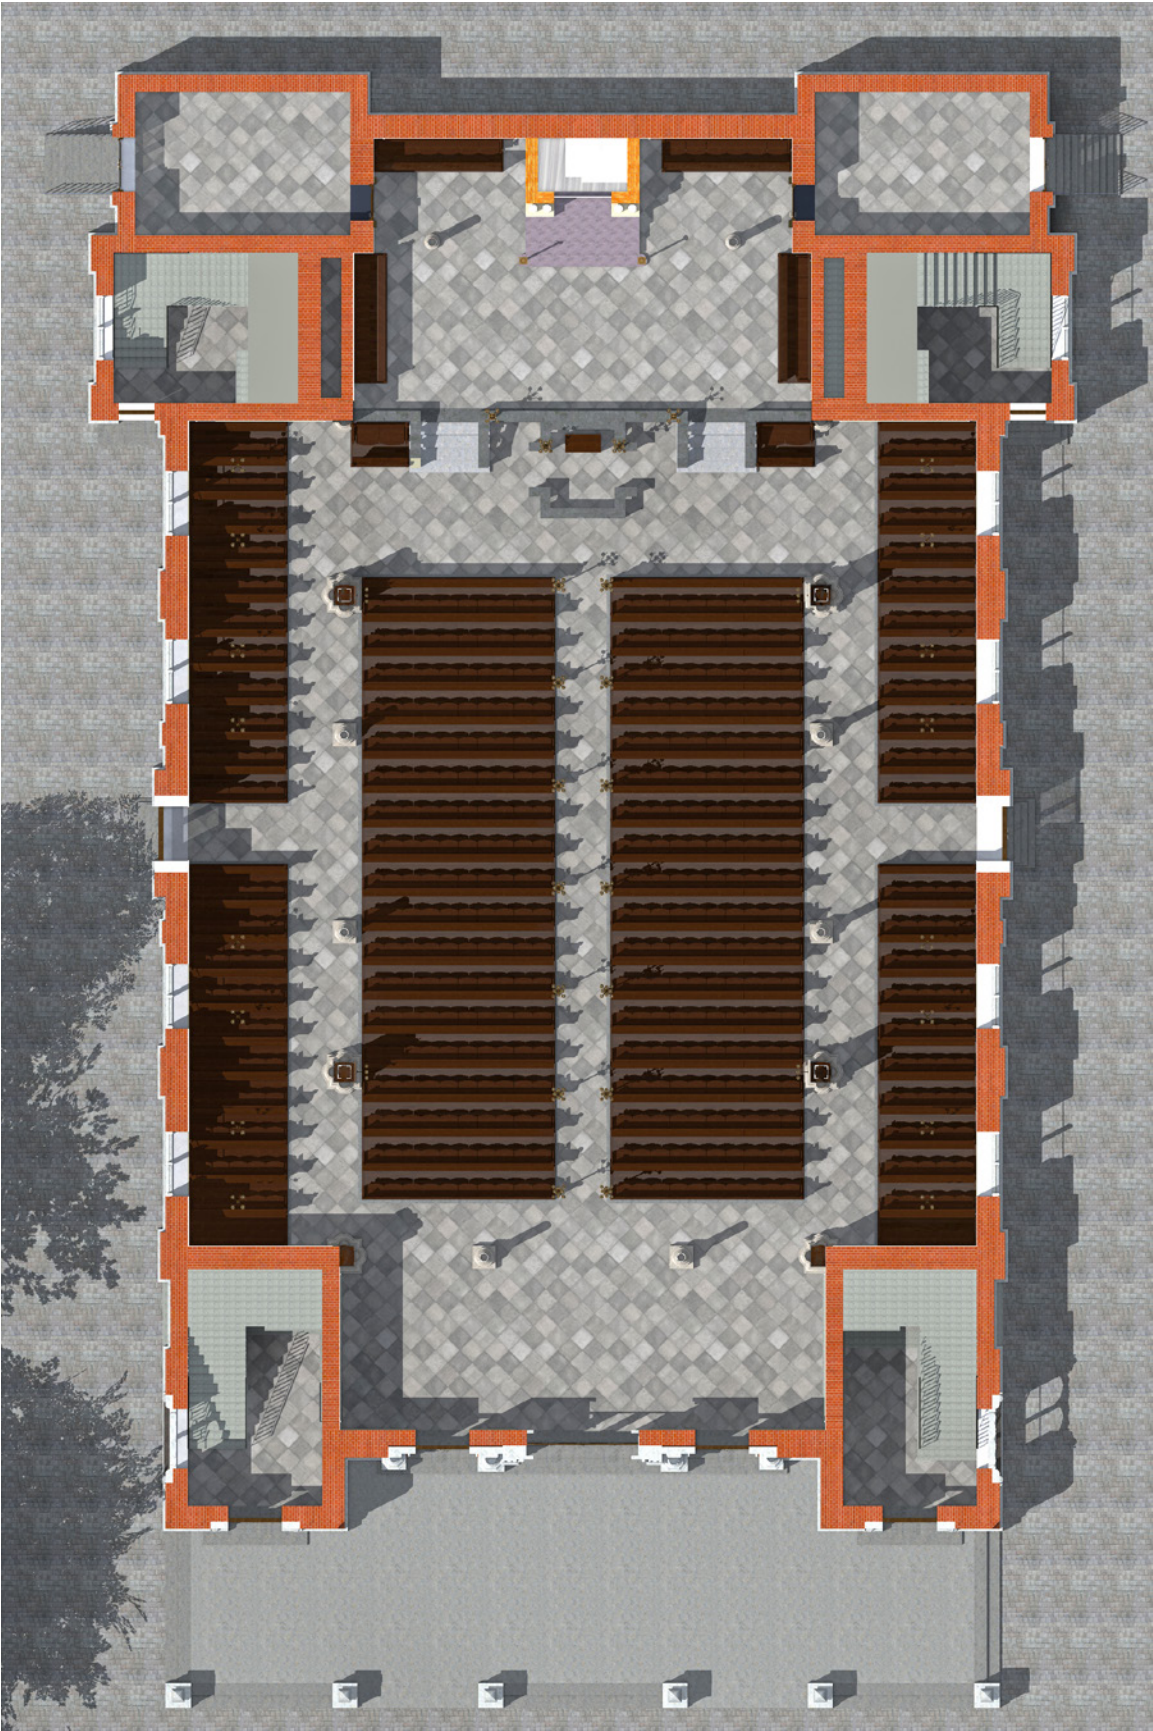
3D Grundriss - Erdgeschoss
